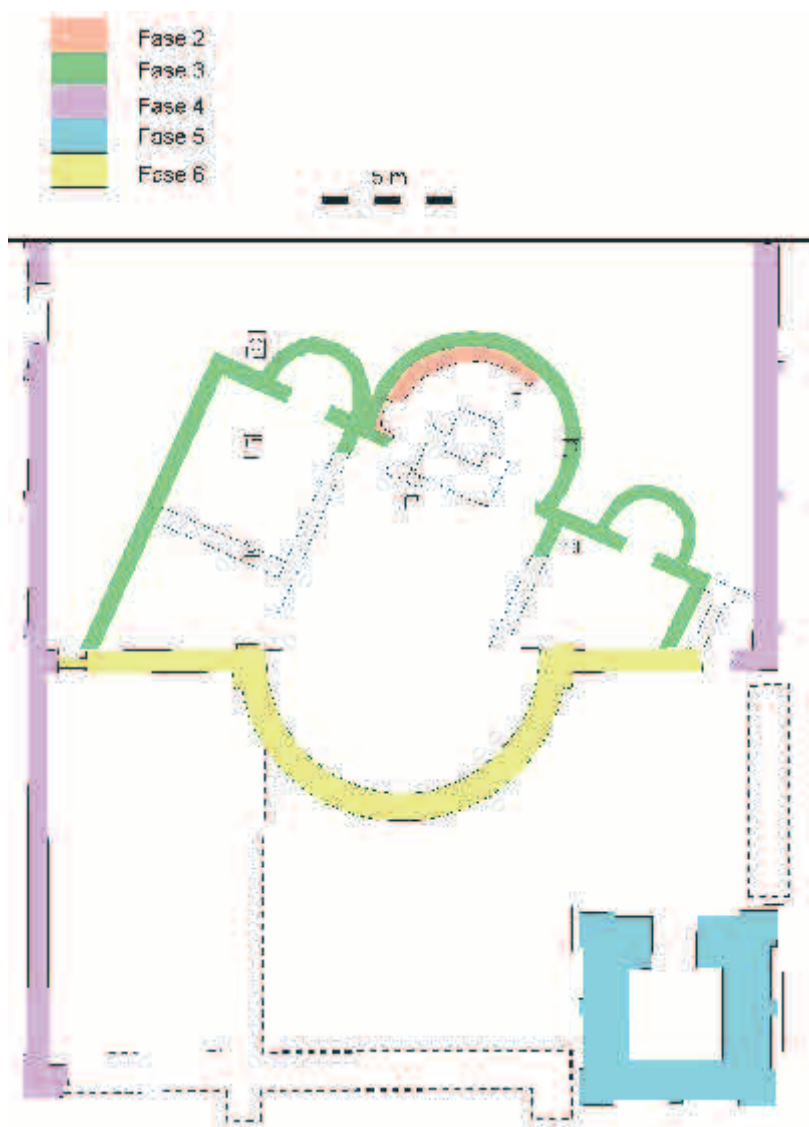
Planta de las estructuras halladas en la excavación realizada en San Piero a Grado, según F. Redi
